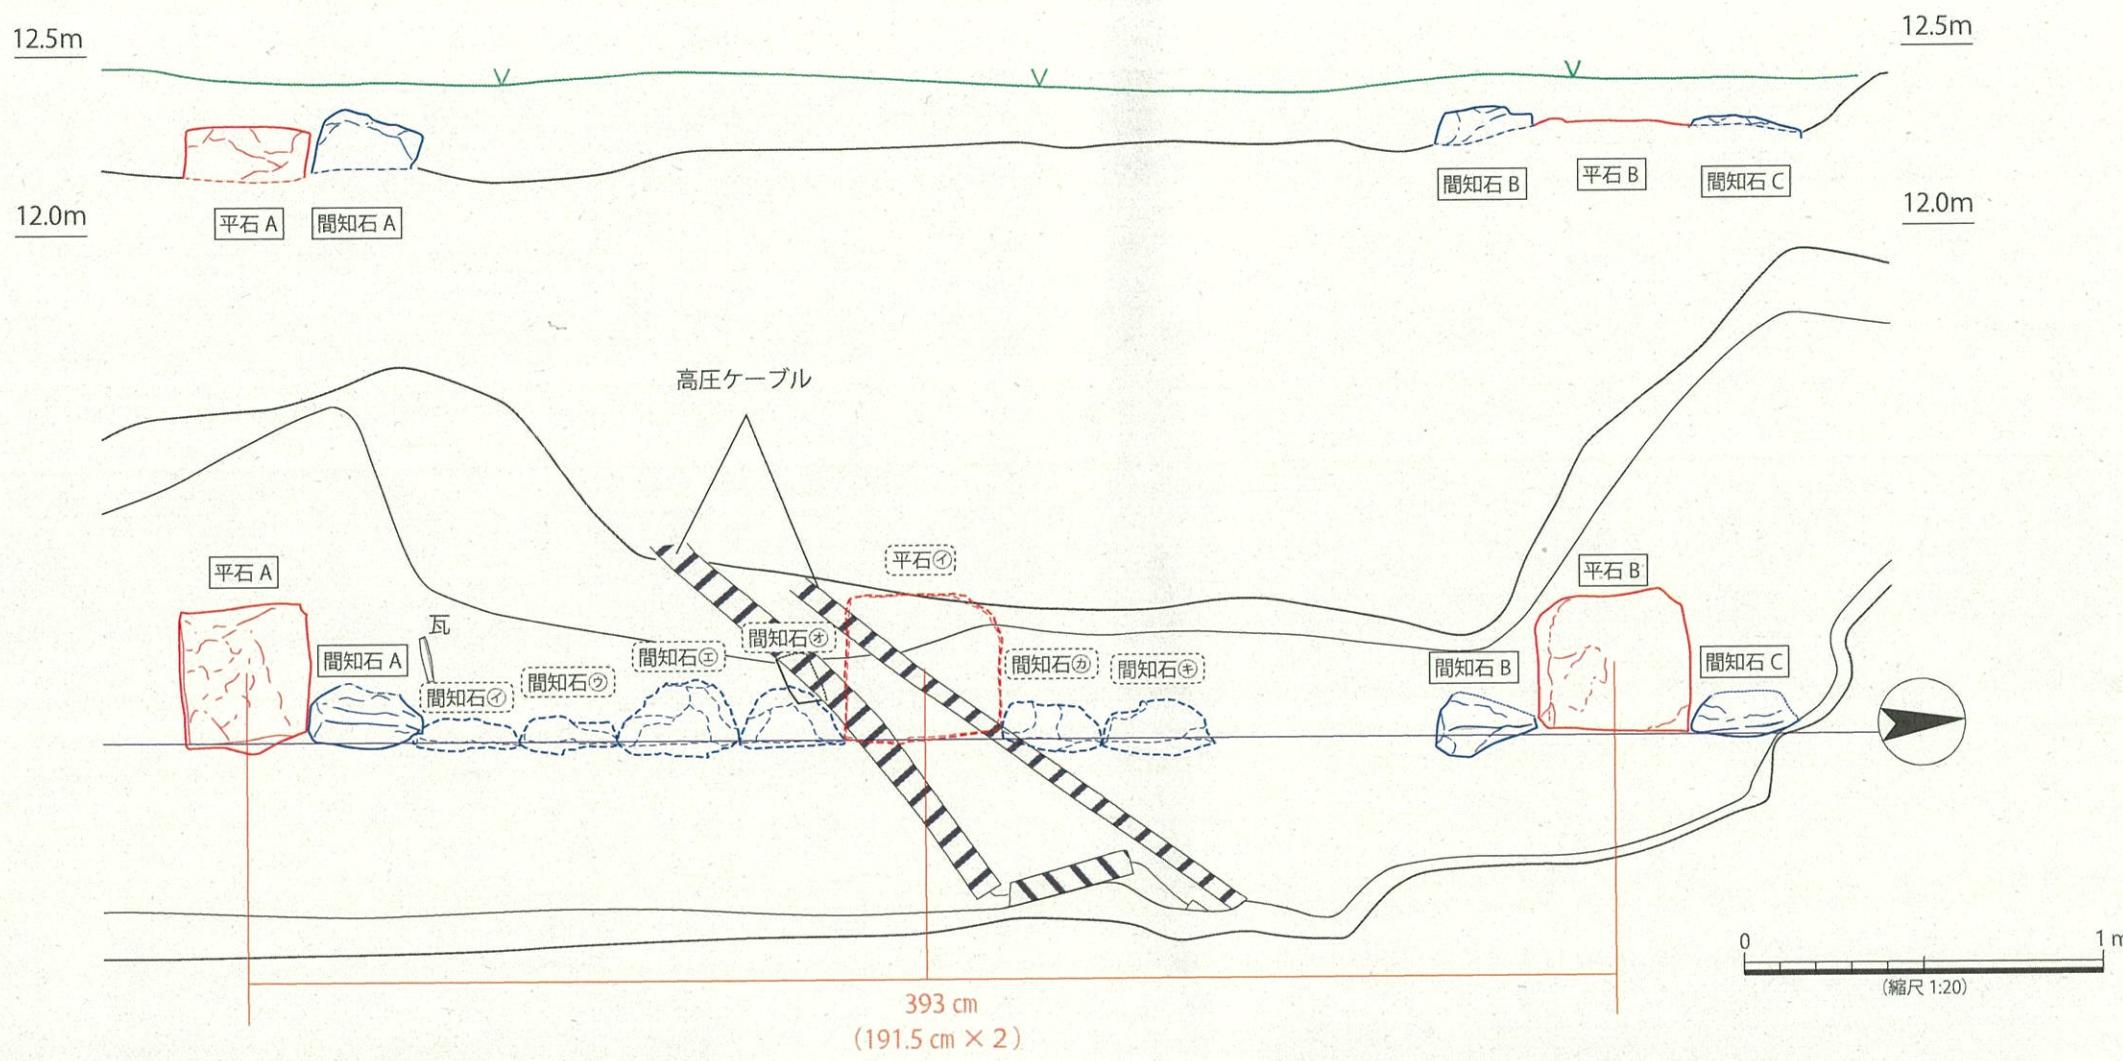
地点①平面図・エレベーション図 (縮尺: 1/20)
